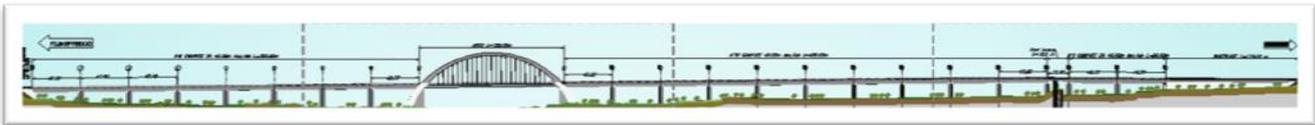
Viadotto Alcantara: sezioni trasversali e prospetti
